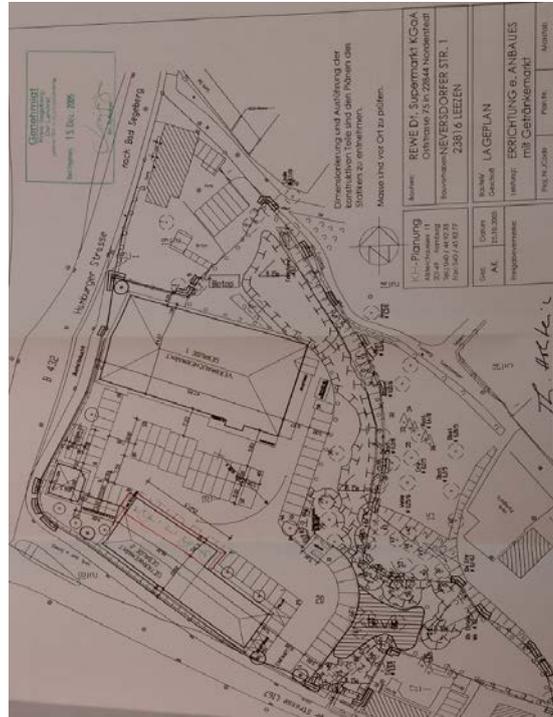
Lageplan der 2000 beantragten Baugenehmigung für den Neubau eines Verbrauchermarktes und zwei Geschäftsgebäuden
